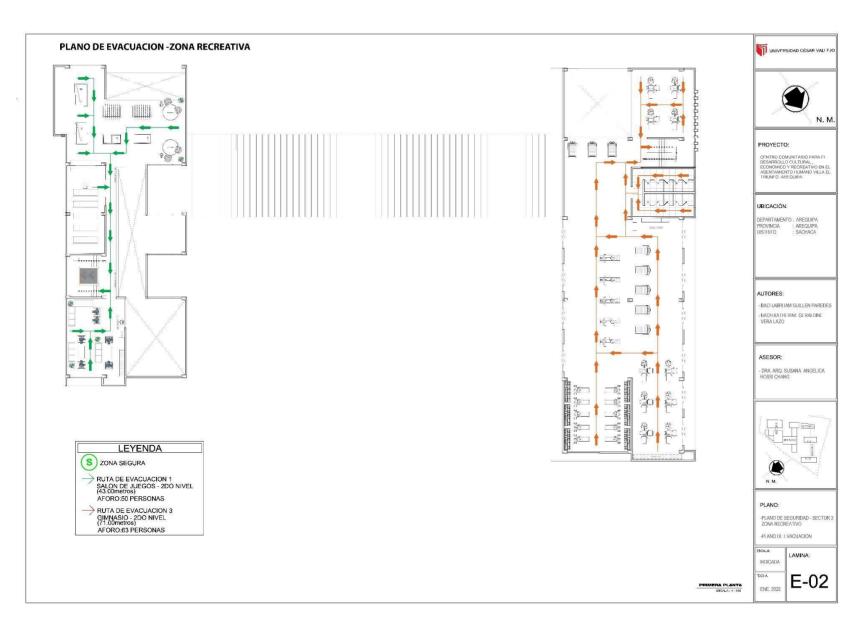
Plano de Evacuación Segunda Planta (Sector 3 - Zona Recreativa) - Elaboración propia
